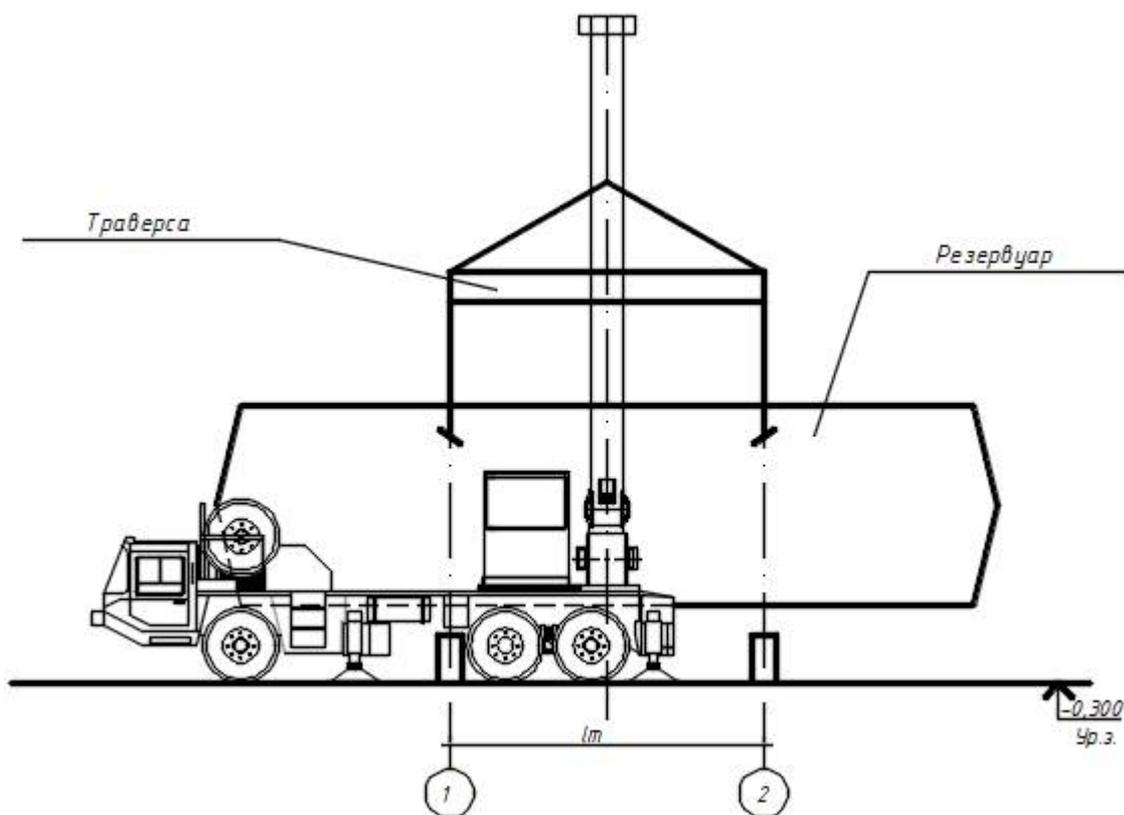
Схема монтажа резервуара с помощью траверсы и строп
